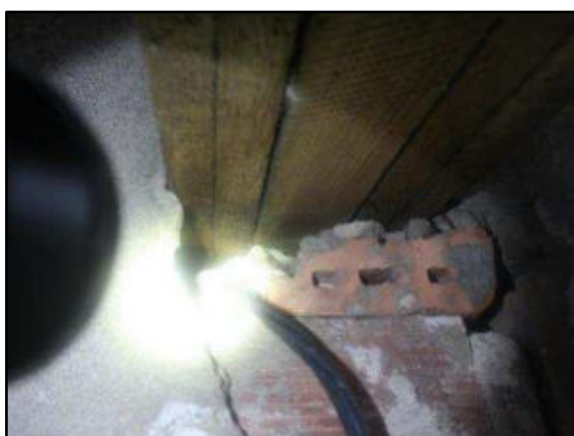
hohlraumbietender Mauerausbruch (potentielles Fledermausquartier) an Außenwand unterhalb Dachauflage nahe Nordwestecke des Gebäudes 3 (Stall)
